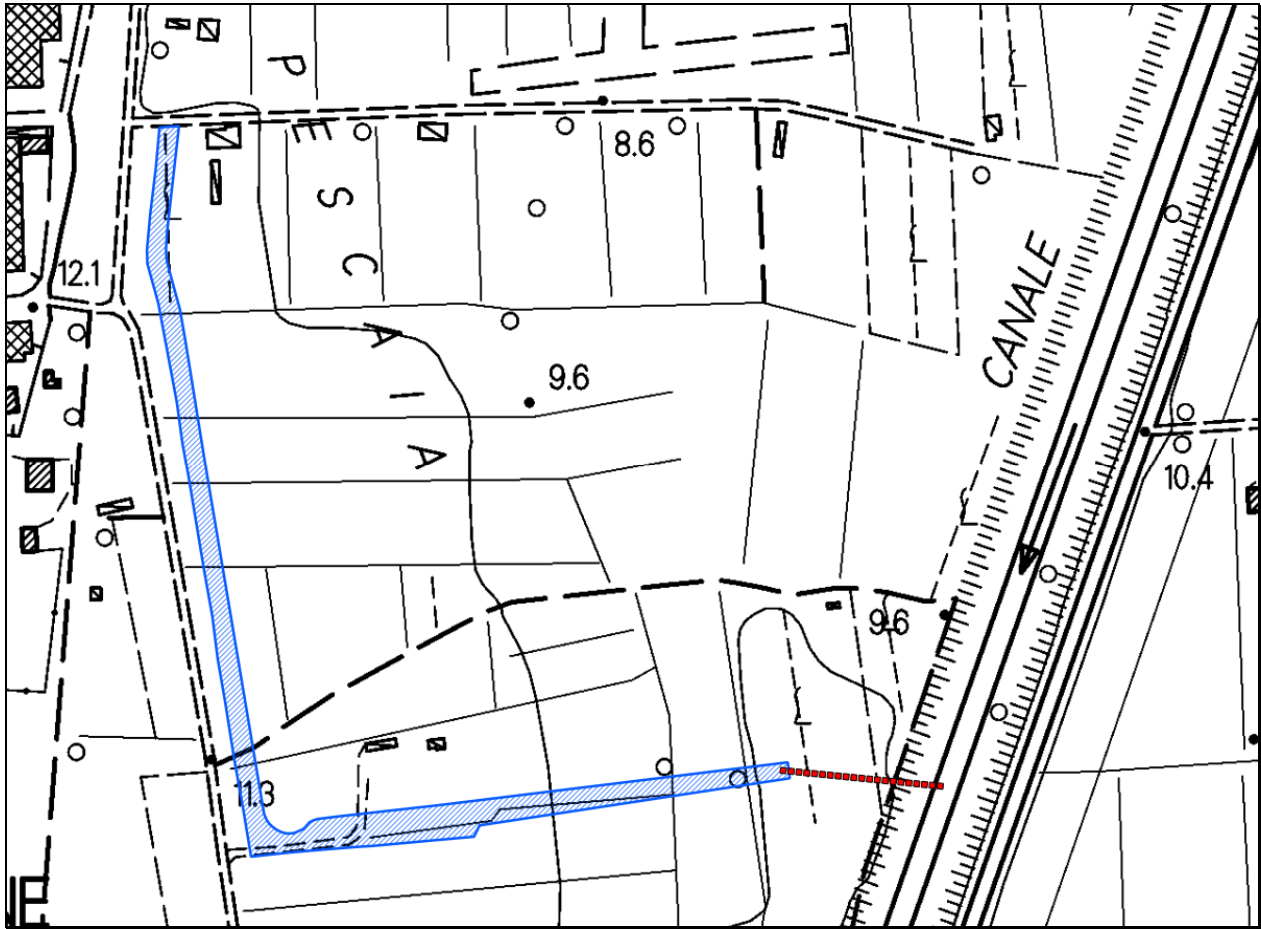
Planimetria con indicazione dello scarico presso il Canale Emissario (in rosso)
